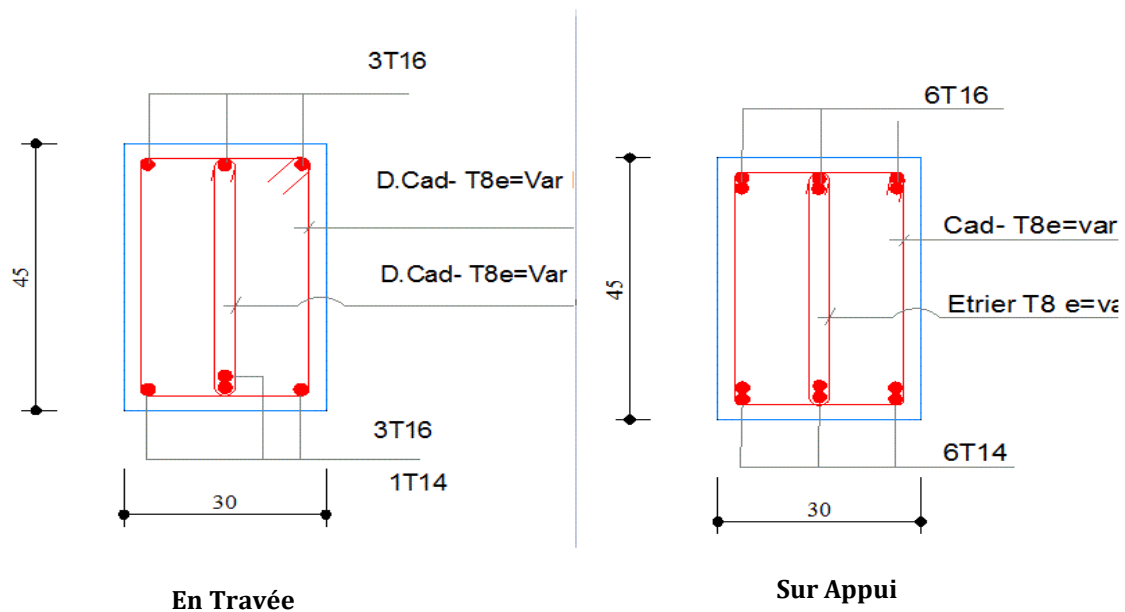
Ferrailage des poutres principales étage courant d'habitation 30\*45
